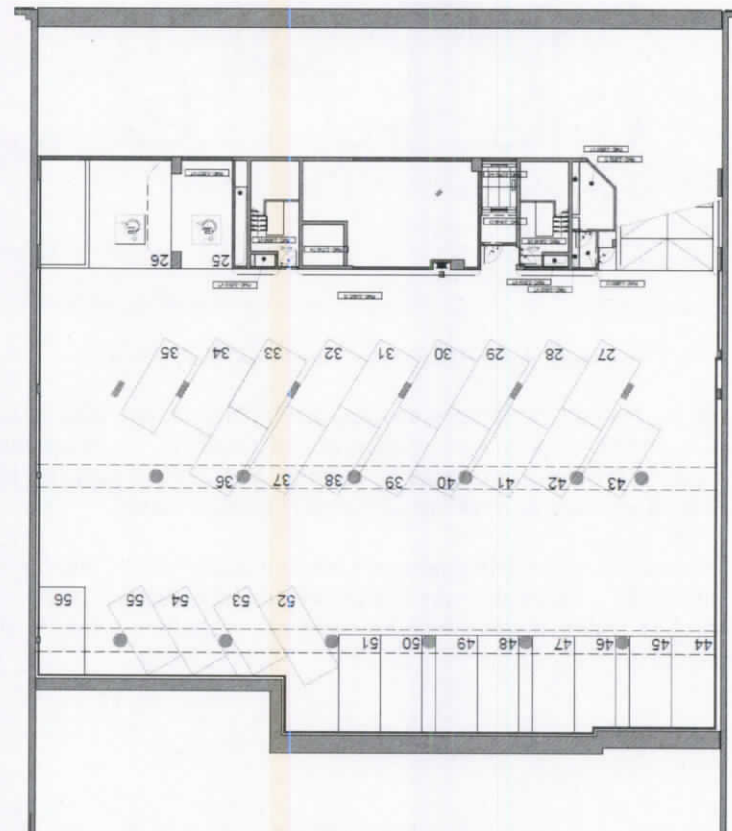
(c) : Parking du Bâtiment REMARD [Niveau -2]
